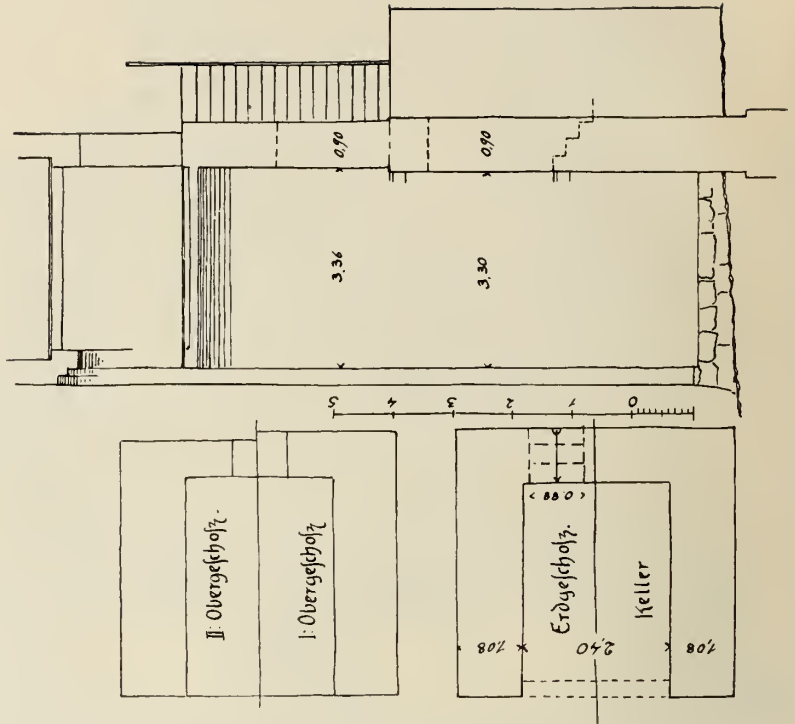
Hannover; Stadtmauerturm auf dem Grundstück Neuer Weg 4. Grundriß und Schnitt des mittelalterlichen Turmkörpers.
